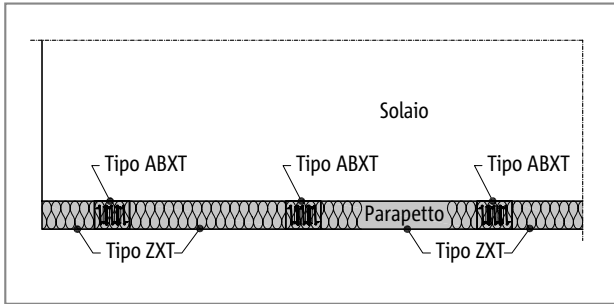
Schöck Isokorb® tipo ABXT - disposizione verticale, pianta del parapetto sovrapposto
